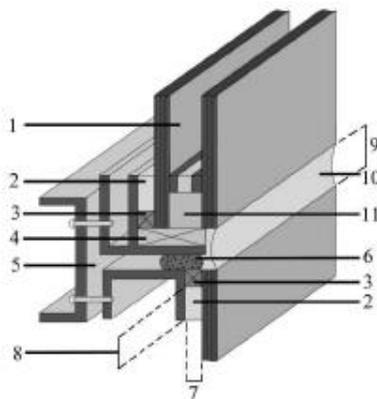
А. Соединительное звено. Примеры конструкций структурного остекления: 2-сторонняя конструкция (устанавливается на строительной площадке)
